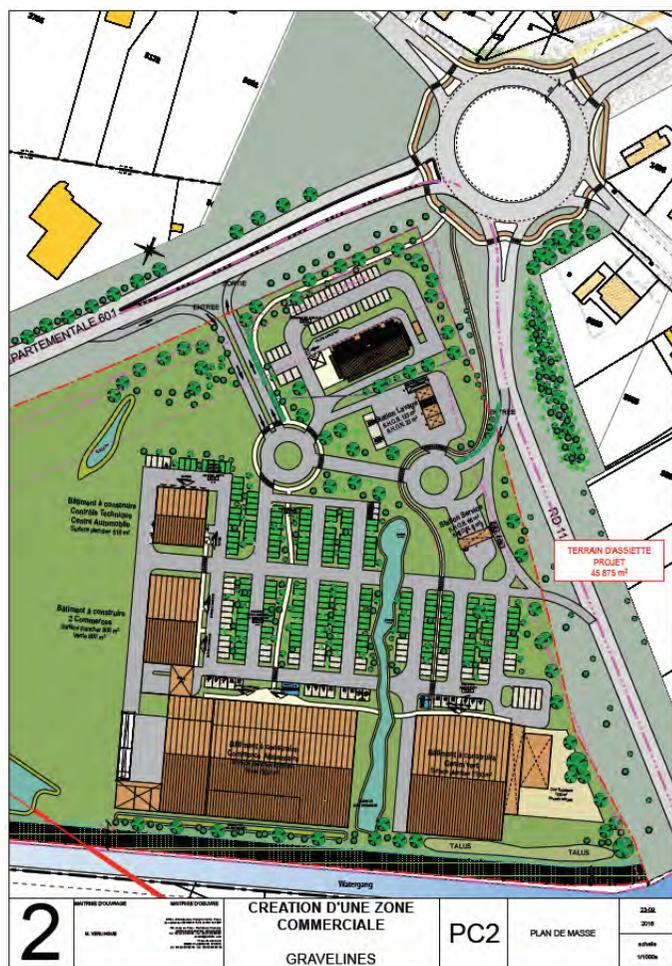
Plan de masse initial de 2016 (source : ARCHIFIX)
